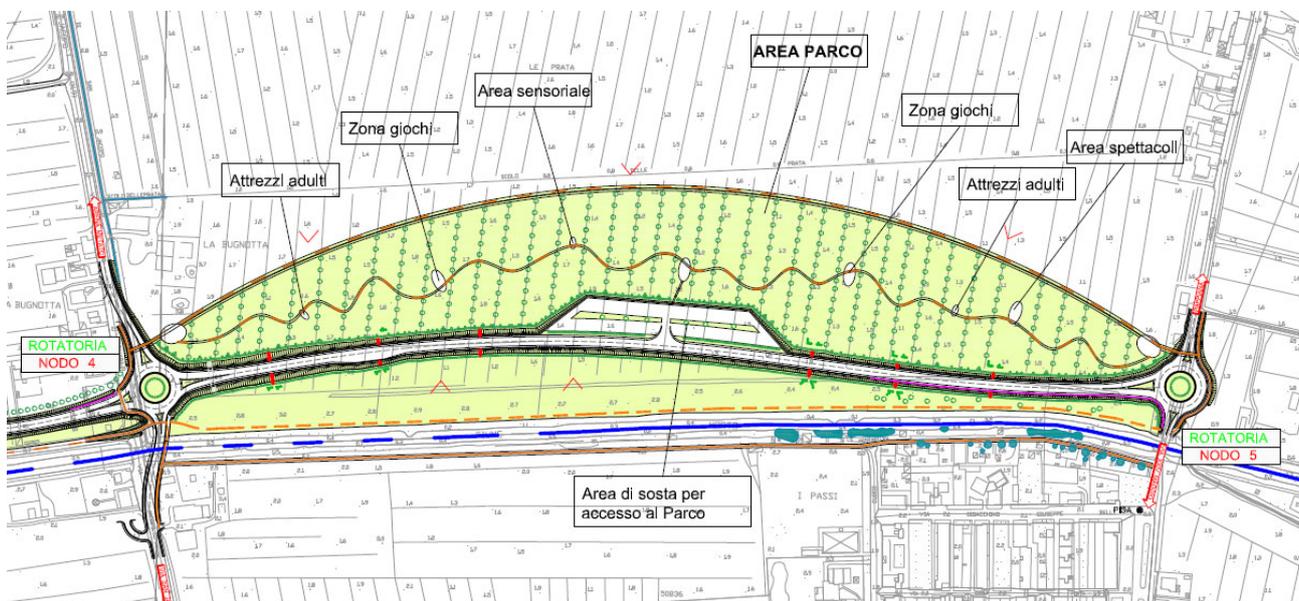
Planimetria area parco tratto nodi 4 e 5
